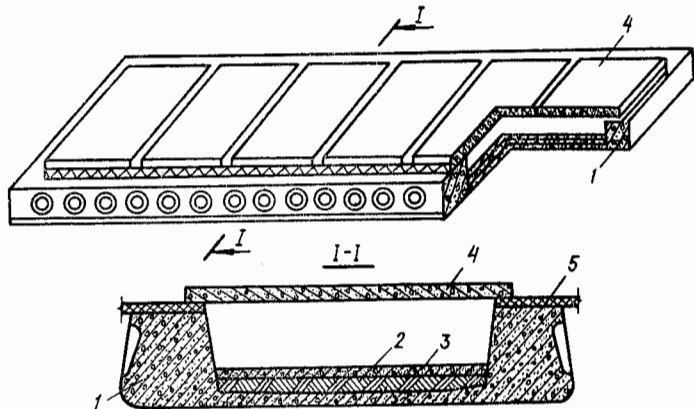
Конструкция междуэтажных несущих панелей перекрытия зданий с повышенными требованиями по звукоизоляции:
